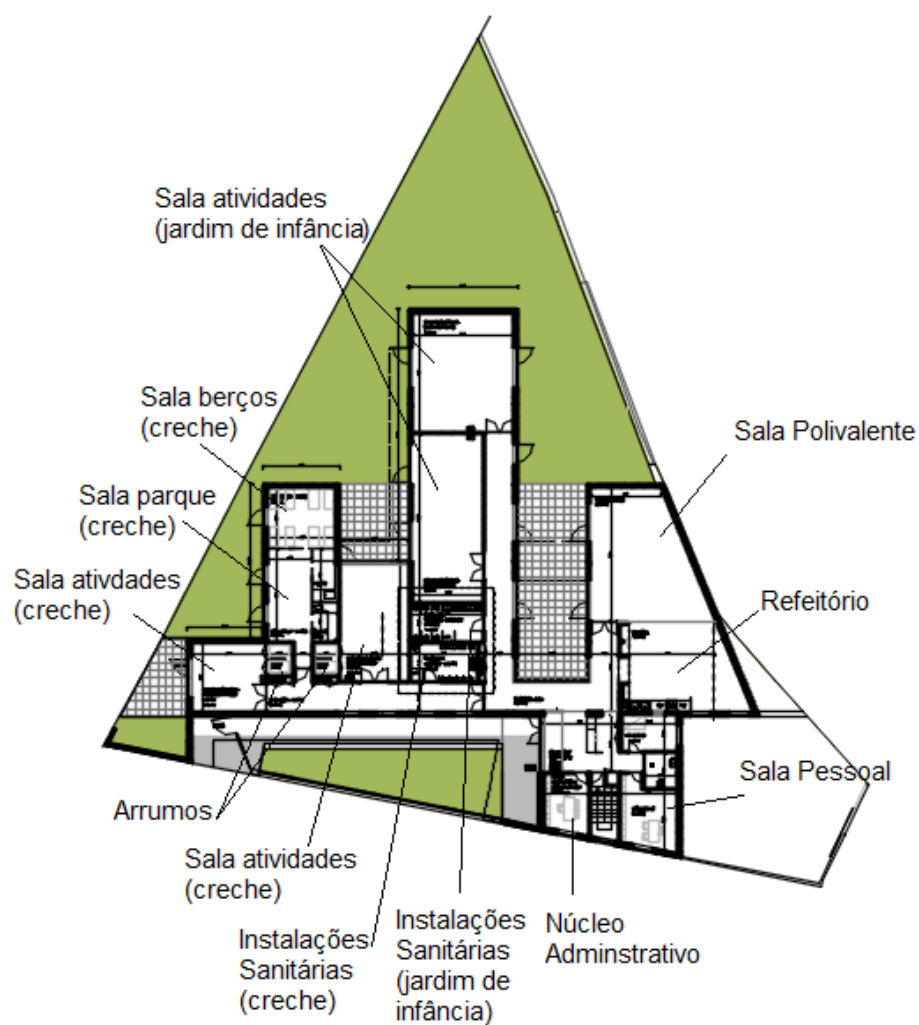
Planta do piso 0 (sem escala) [69]
